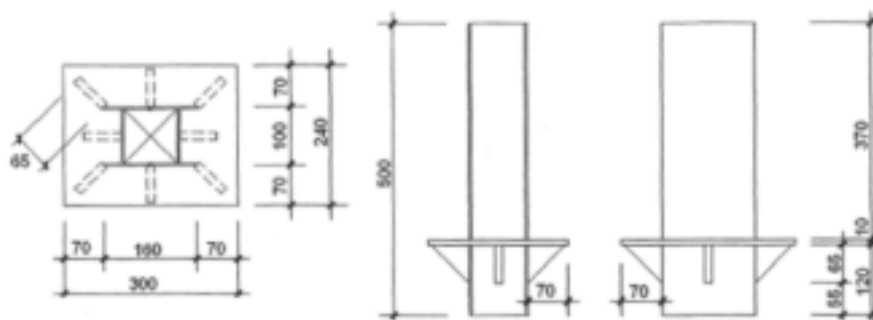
Detalhe do pilar metálico (medidas em mm)
